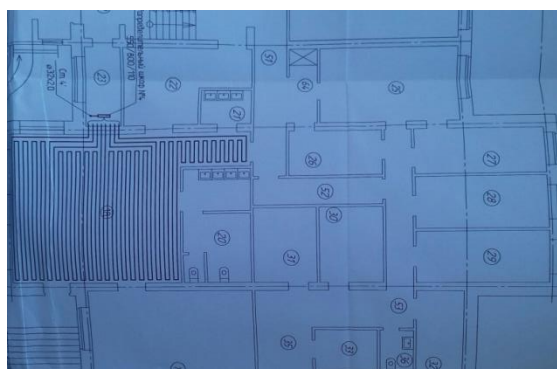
Фрагмент плана 1-го этажа. По оси 10-11
